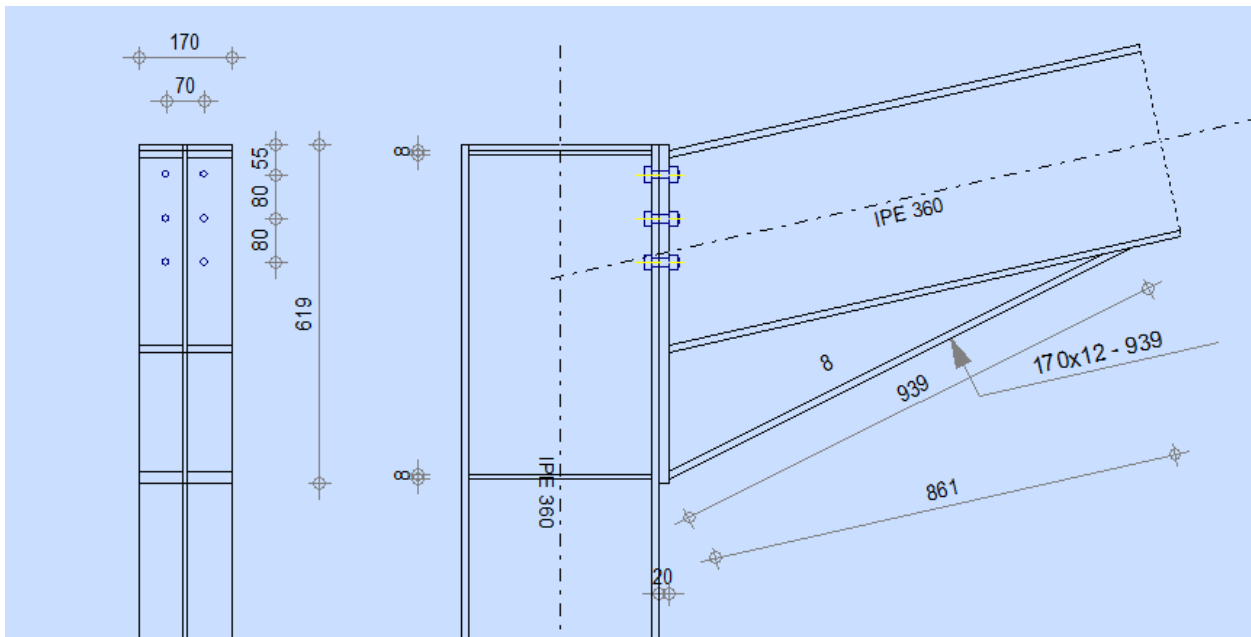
assemblage poteau IPE 360-poutre IPE 360
